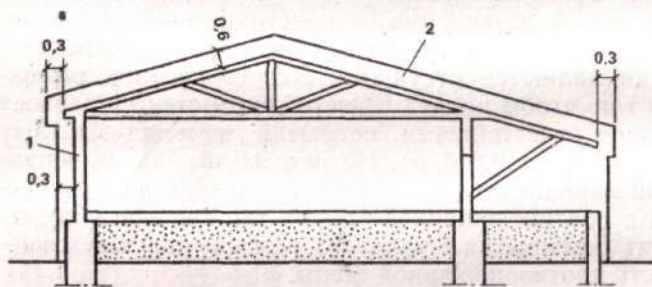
Перерезание противопожарными стенами наружных ограждающих конструкций
